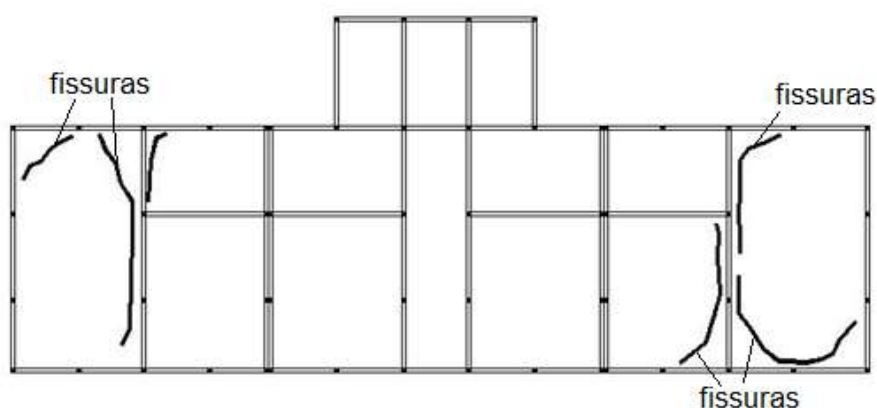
Planta de formas do piso com identificação das fissuras ou trincas existentes
